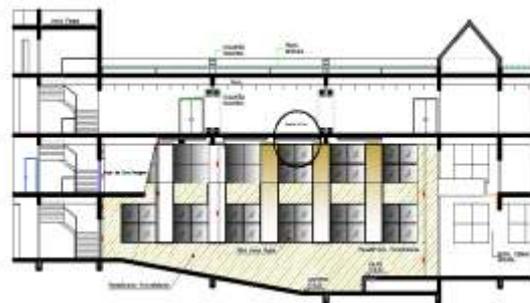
Planta de corte com detalhamento dos materiais acústicos
